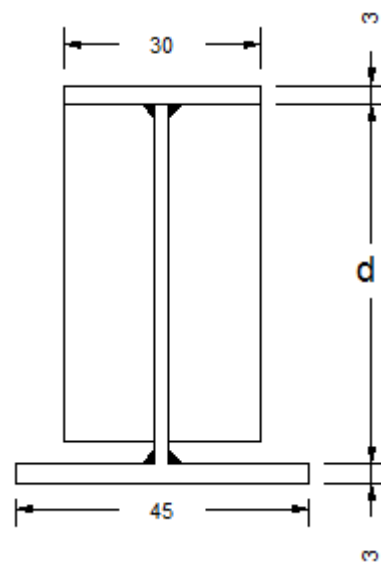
Ubicación del cordón de soldadura patín superior e inferior con el alma de viga (vista frontal)
